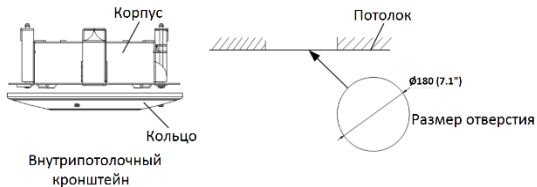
Подготовка отверстия для установки камеры в потолок
